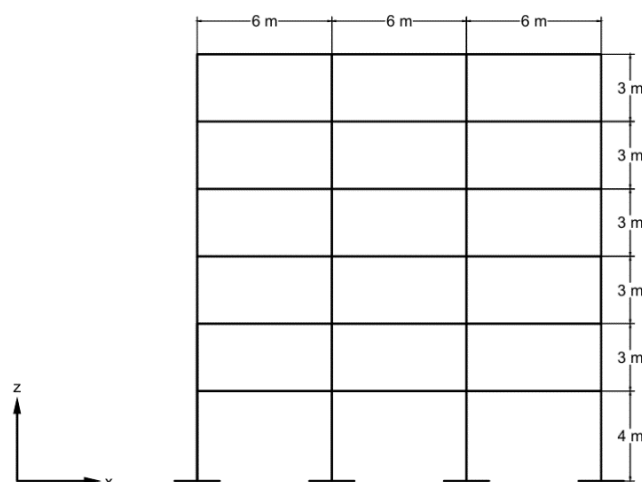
Vista em alçado do sistema estrutural do edifício de 6 pisos
